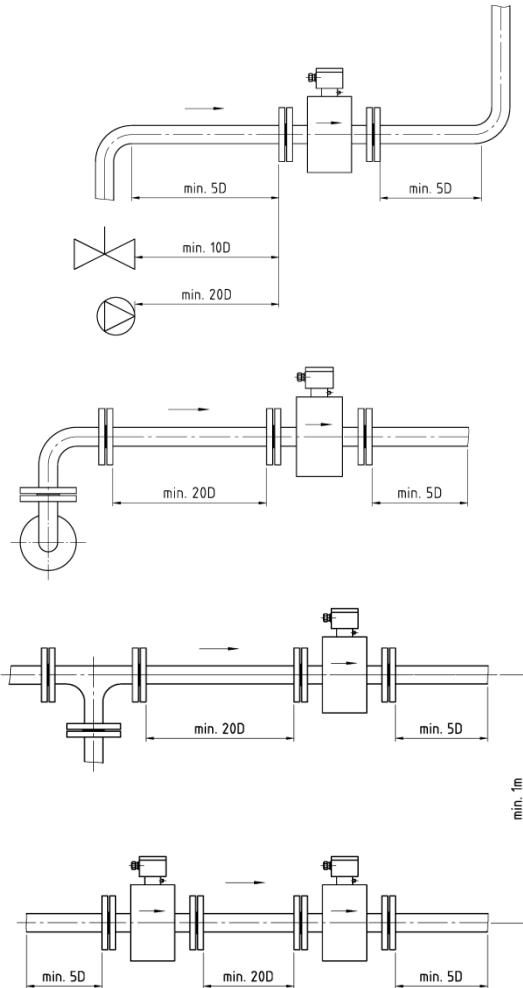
Einbau zwischen Rohrkrümmern, Ventilen und Pumpen
